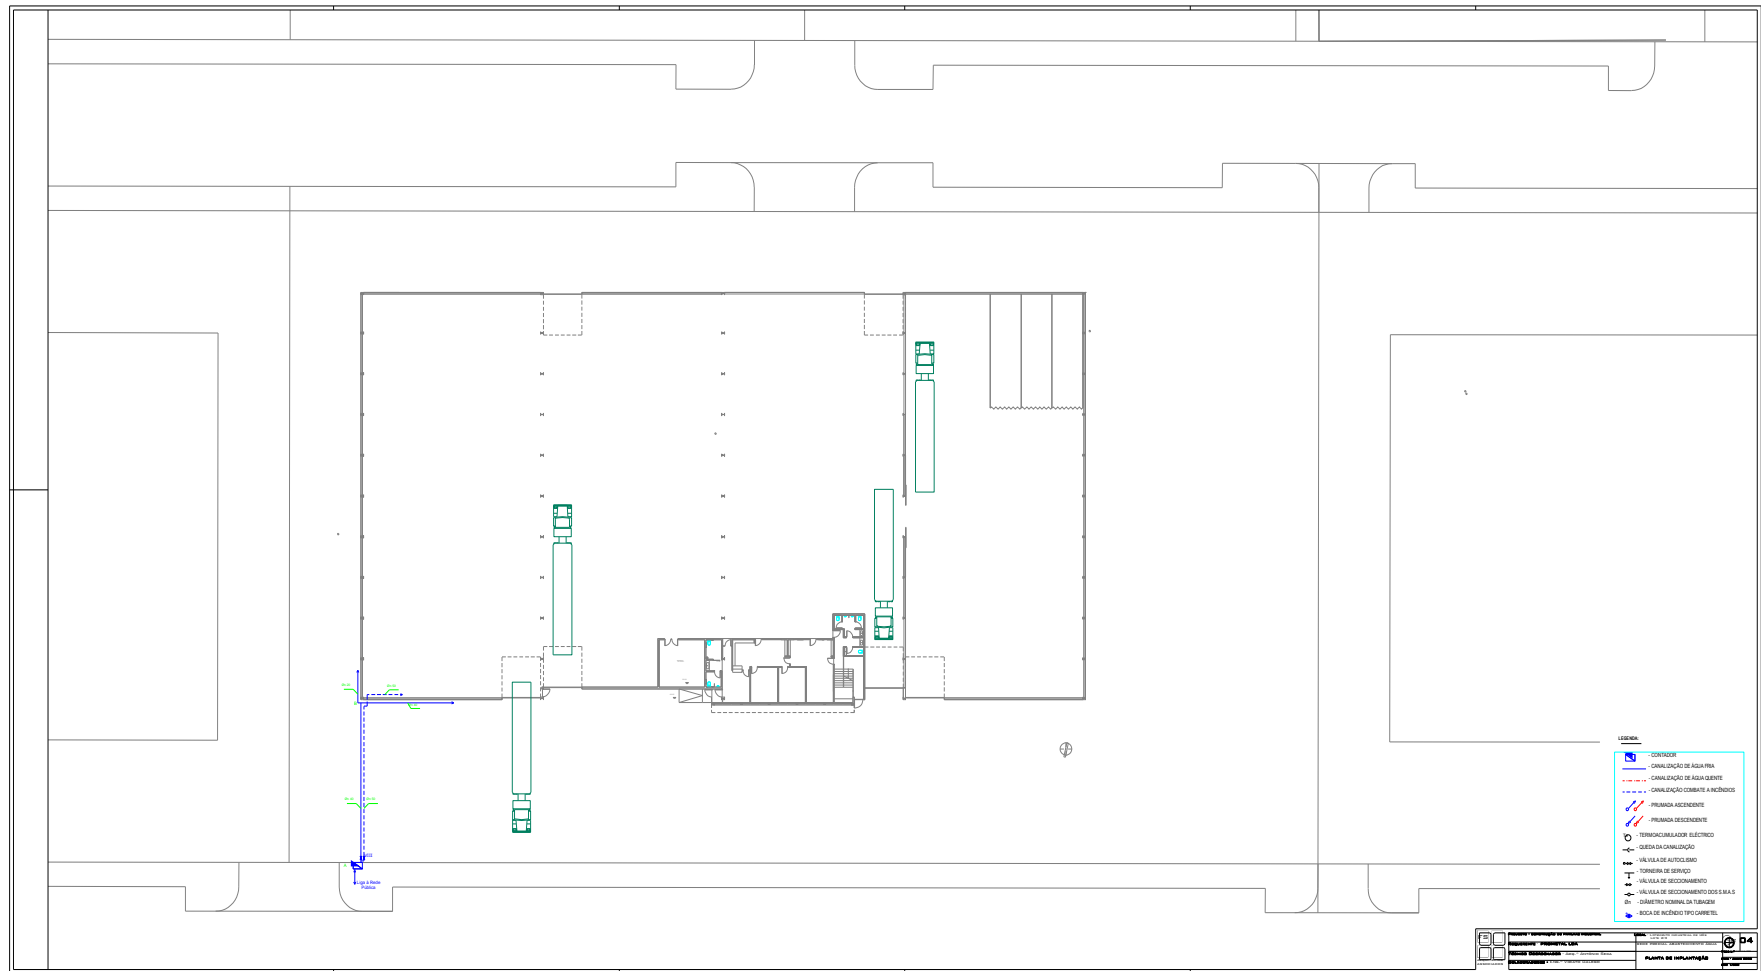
Planta da rede predial de distribuição de água – Implantação
